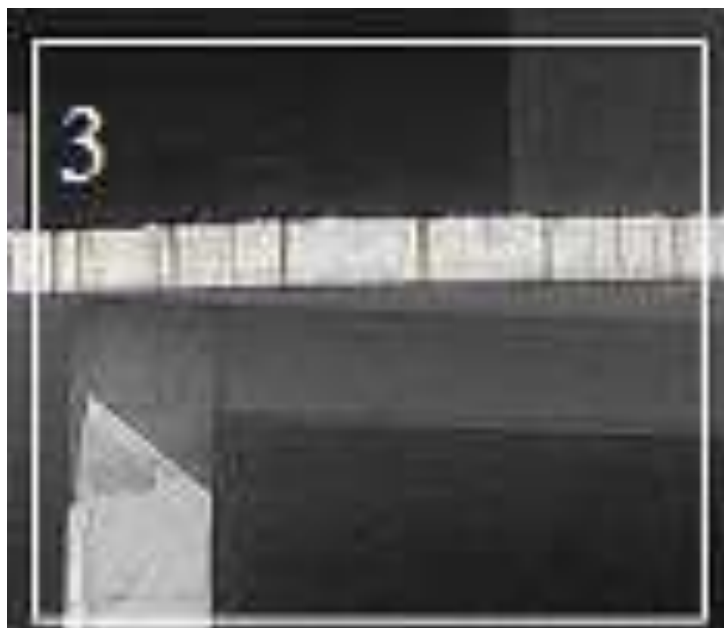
Збільшений фрагмент 3. Корозія арматури бетону на балконних плитах
